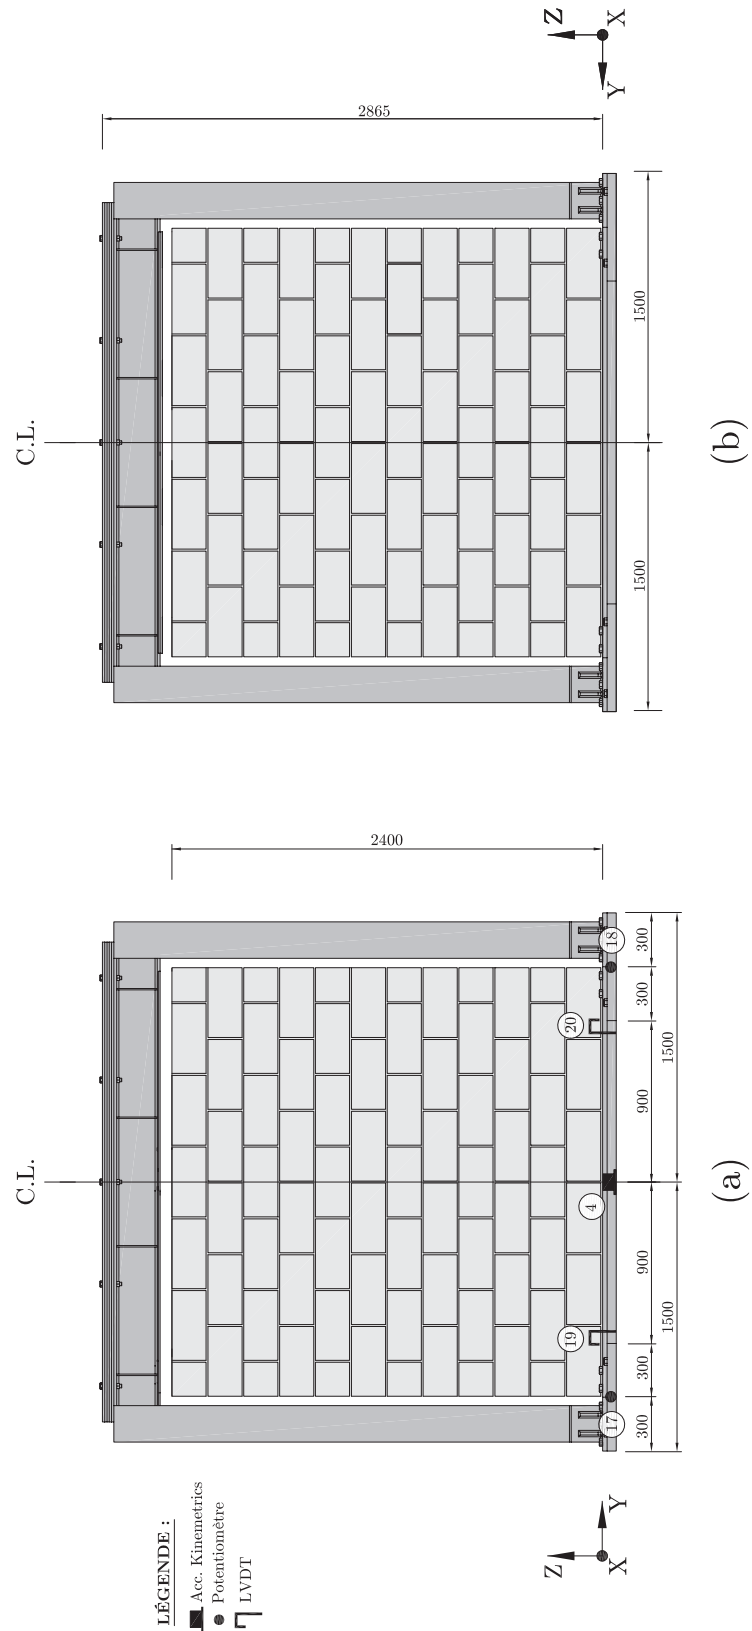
Plan de l'instrumentation du 3<sup>e</sup> mur (a) façade avant du mur (b) façade arrière du mur
